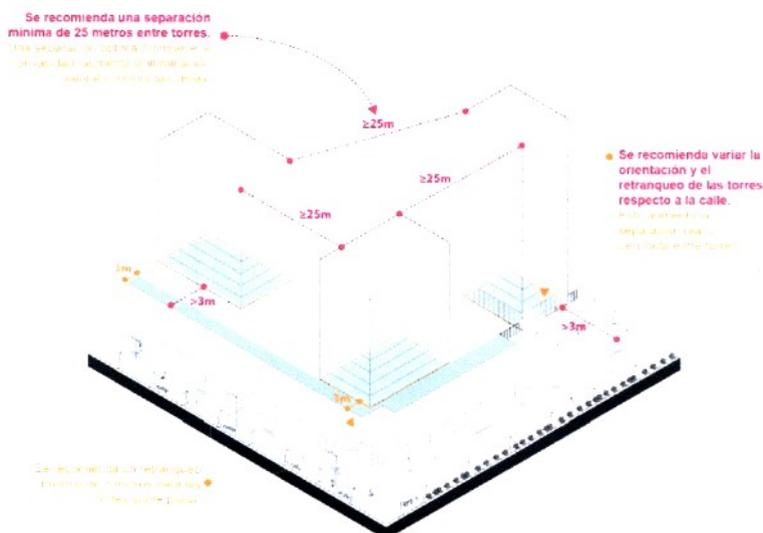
Guía de diseño para la separación, distanciamiento y orientación entre edificaciones en altura.
